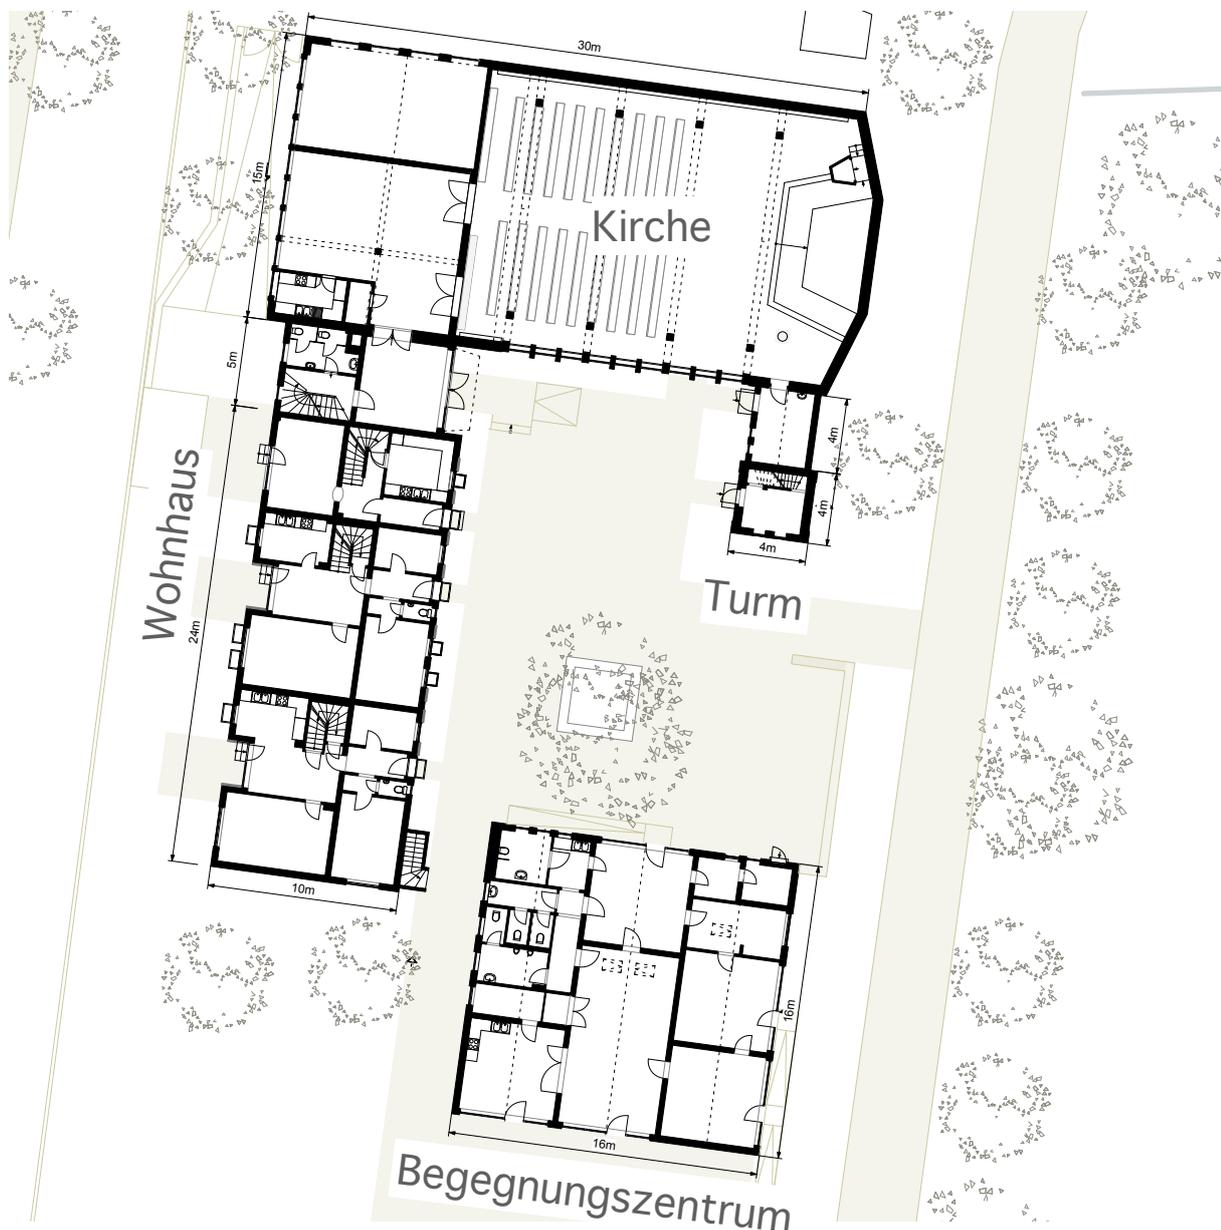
Grundriss EG Bestand, M 1:400
